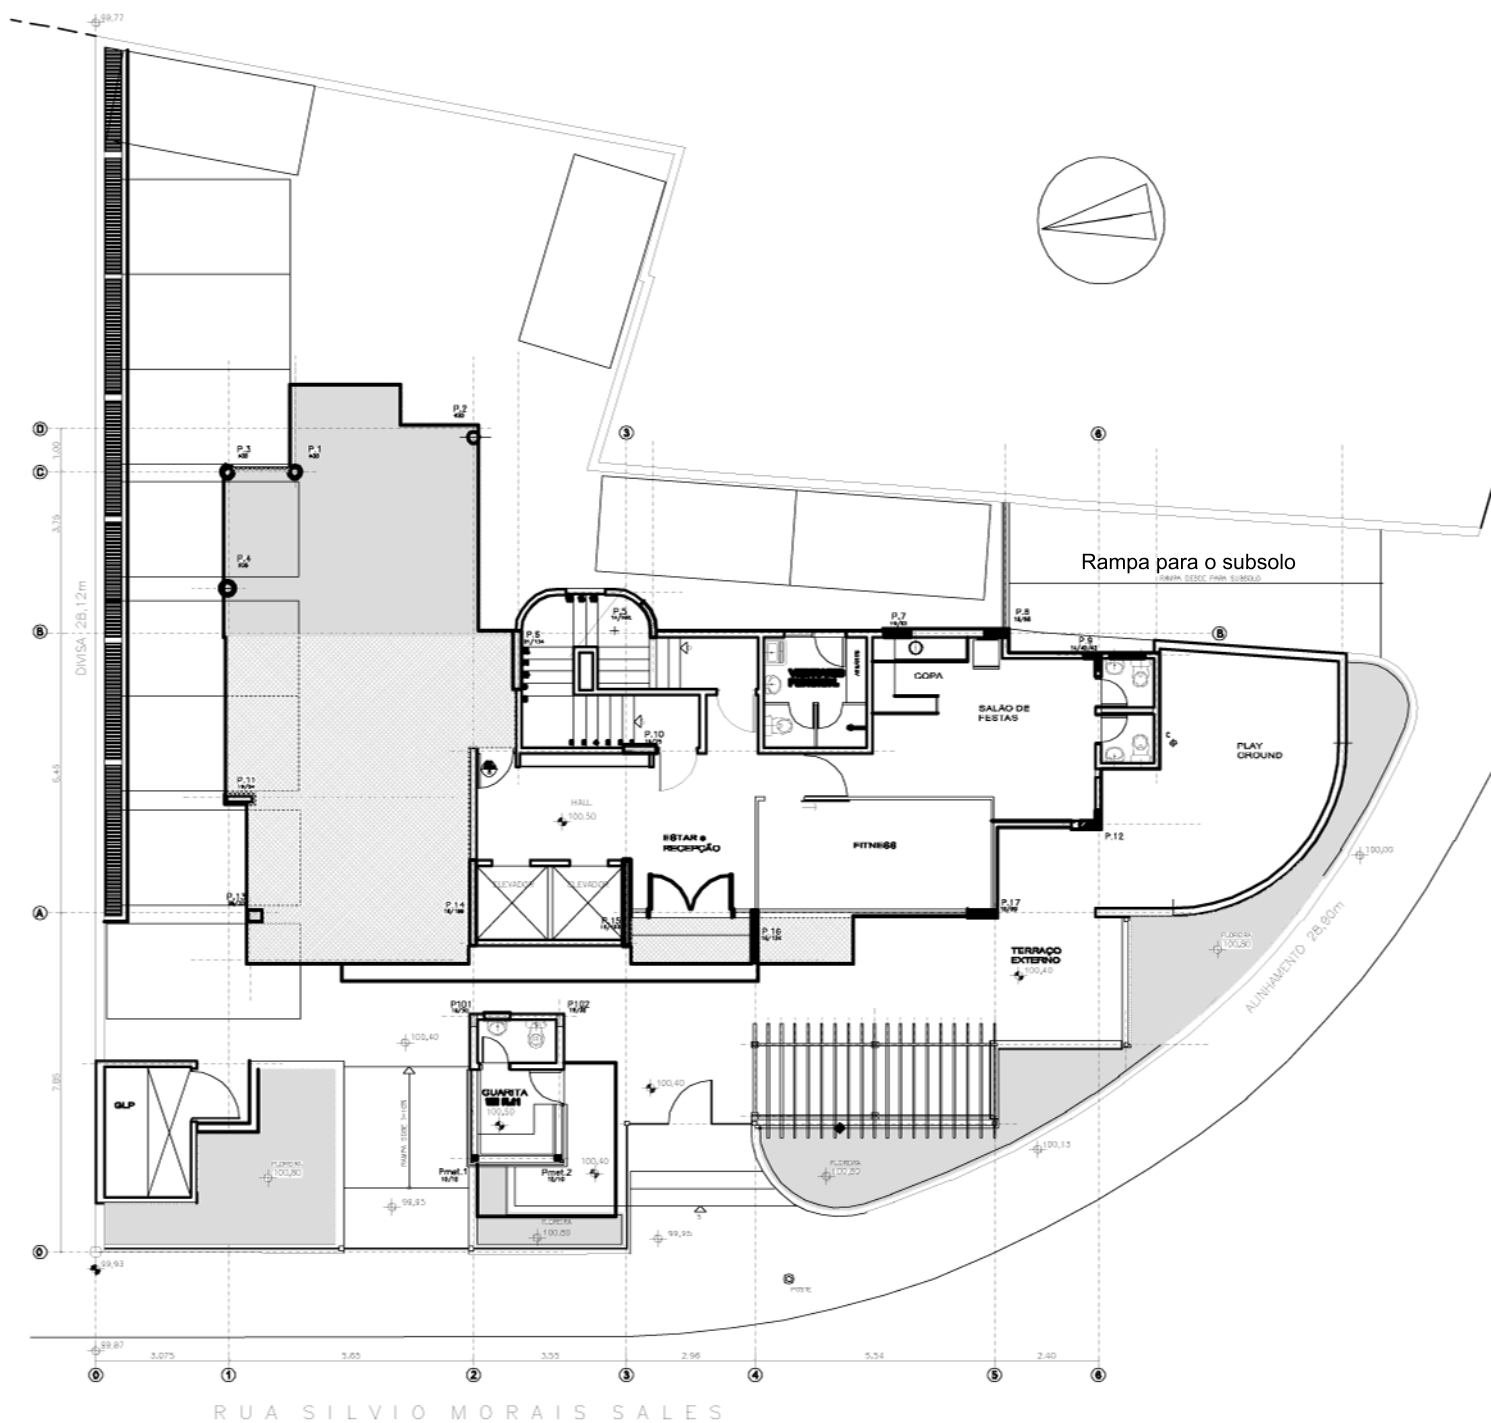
Planta do pavimento térreo do Edifício Rennes. Fonte: Arquivo do autor.
